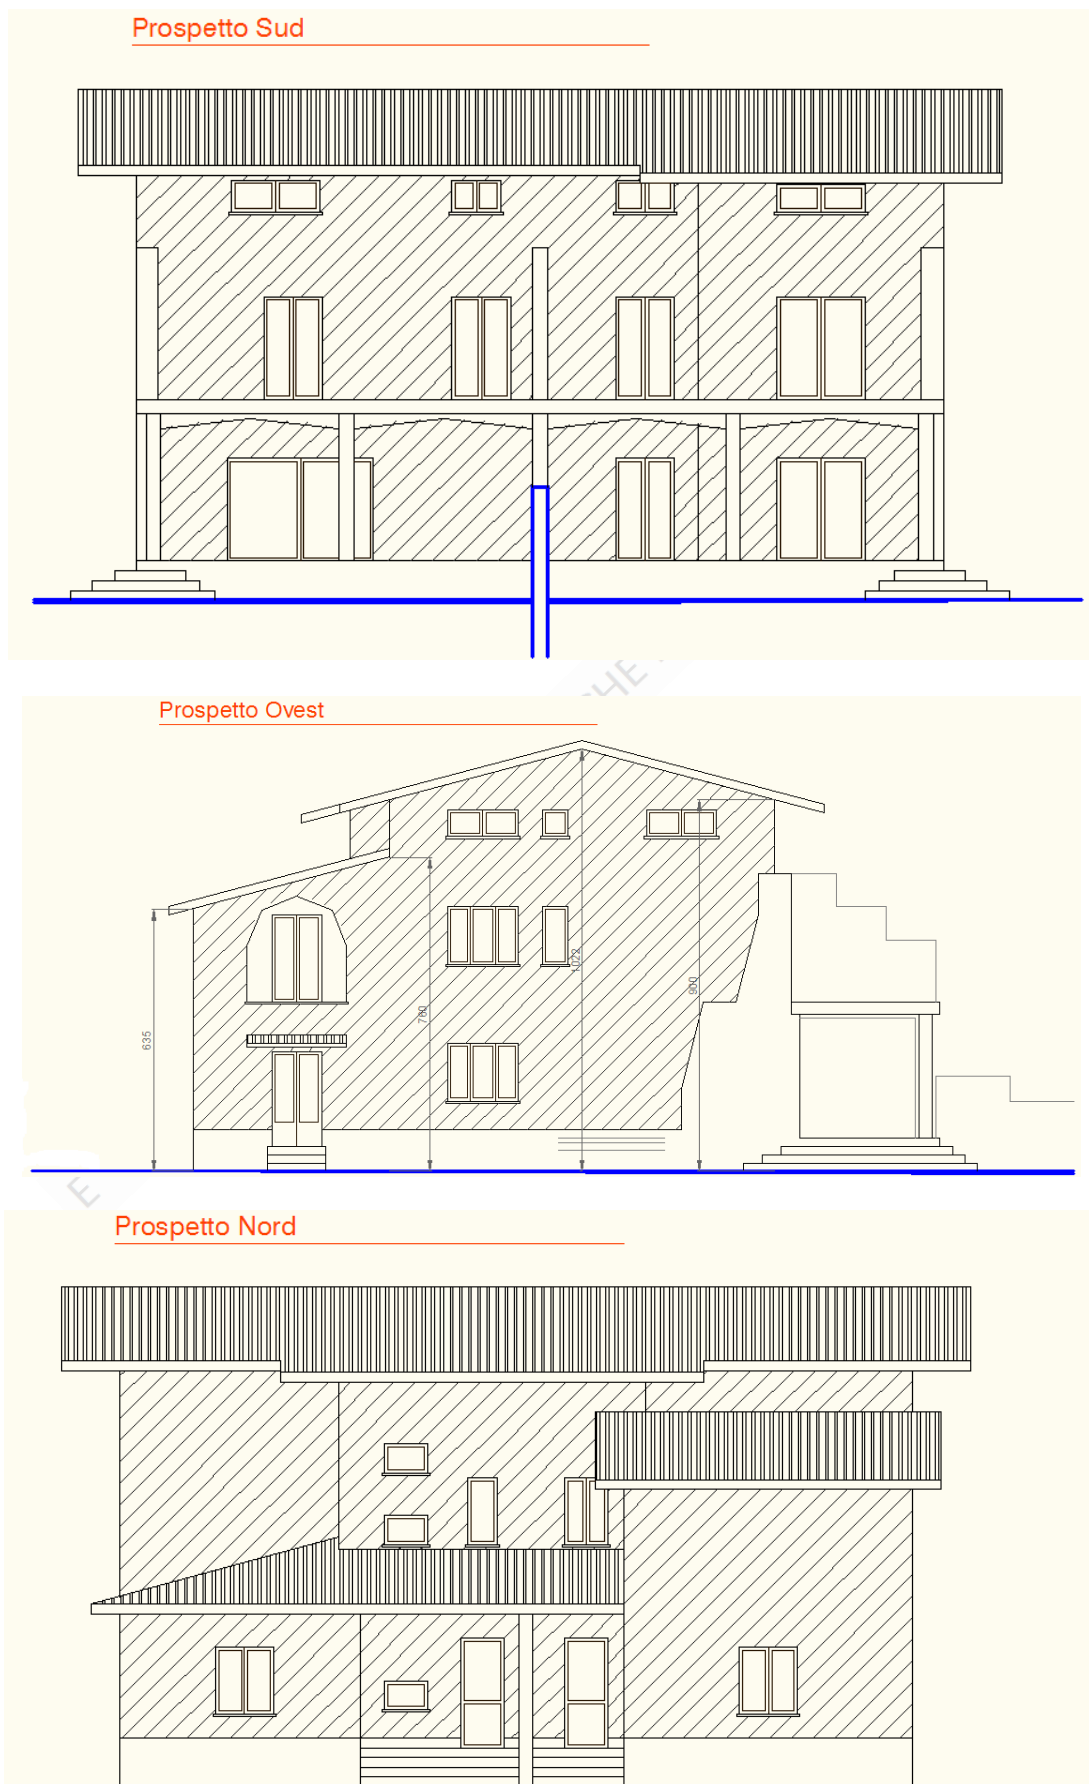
Prospetti dell'edificio oggetto di studio
